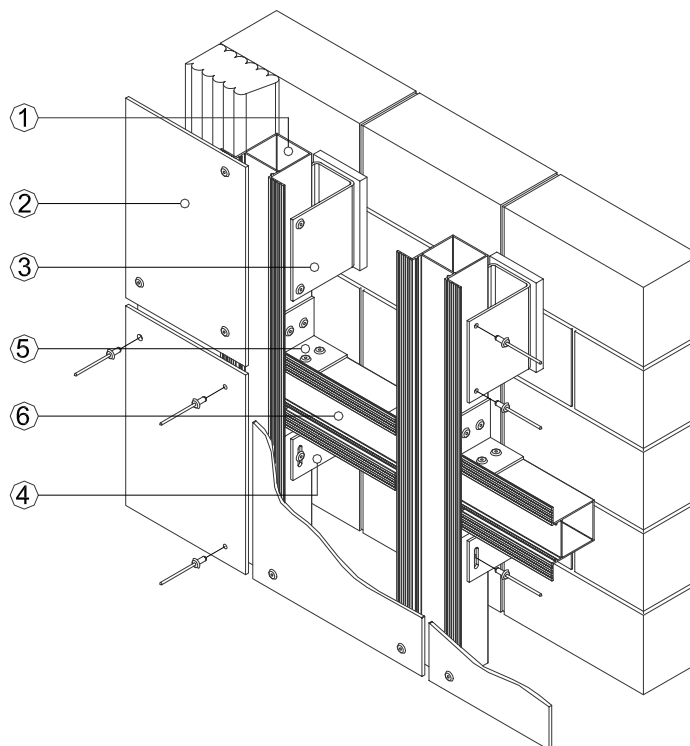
Revestimiento de fachadas ventiladas a base de placas remachadas sobre subestructura bidireccional
